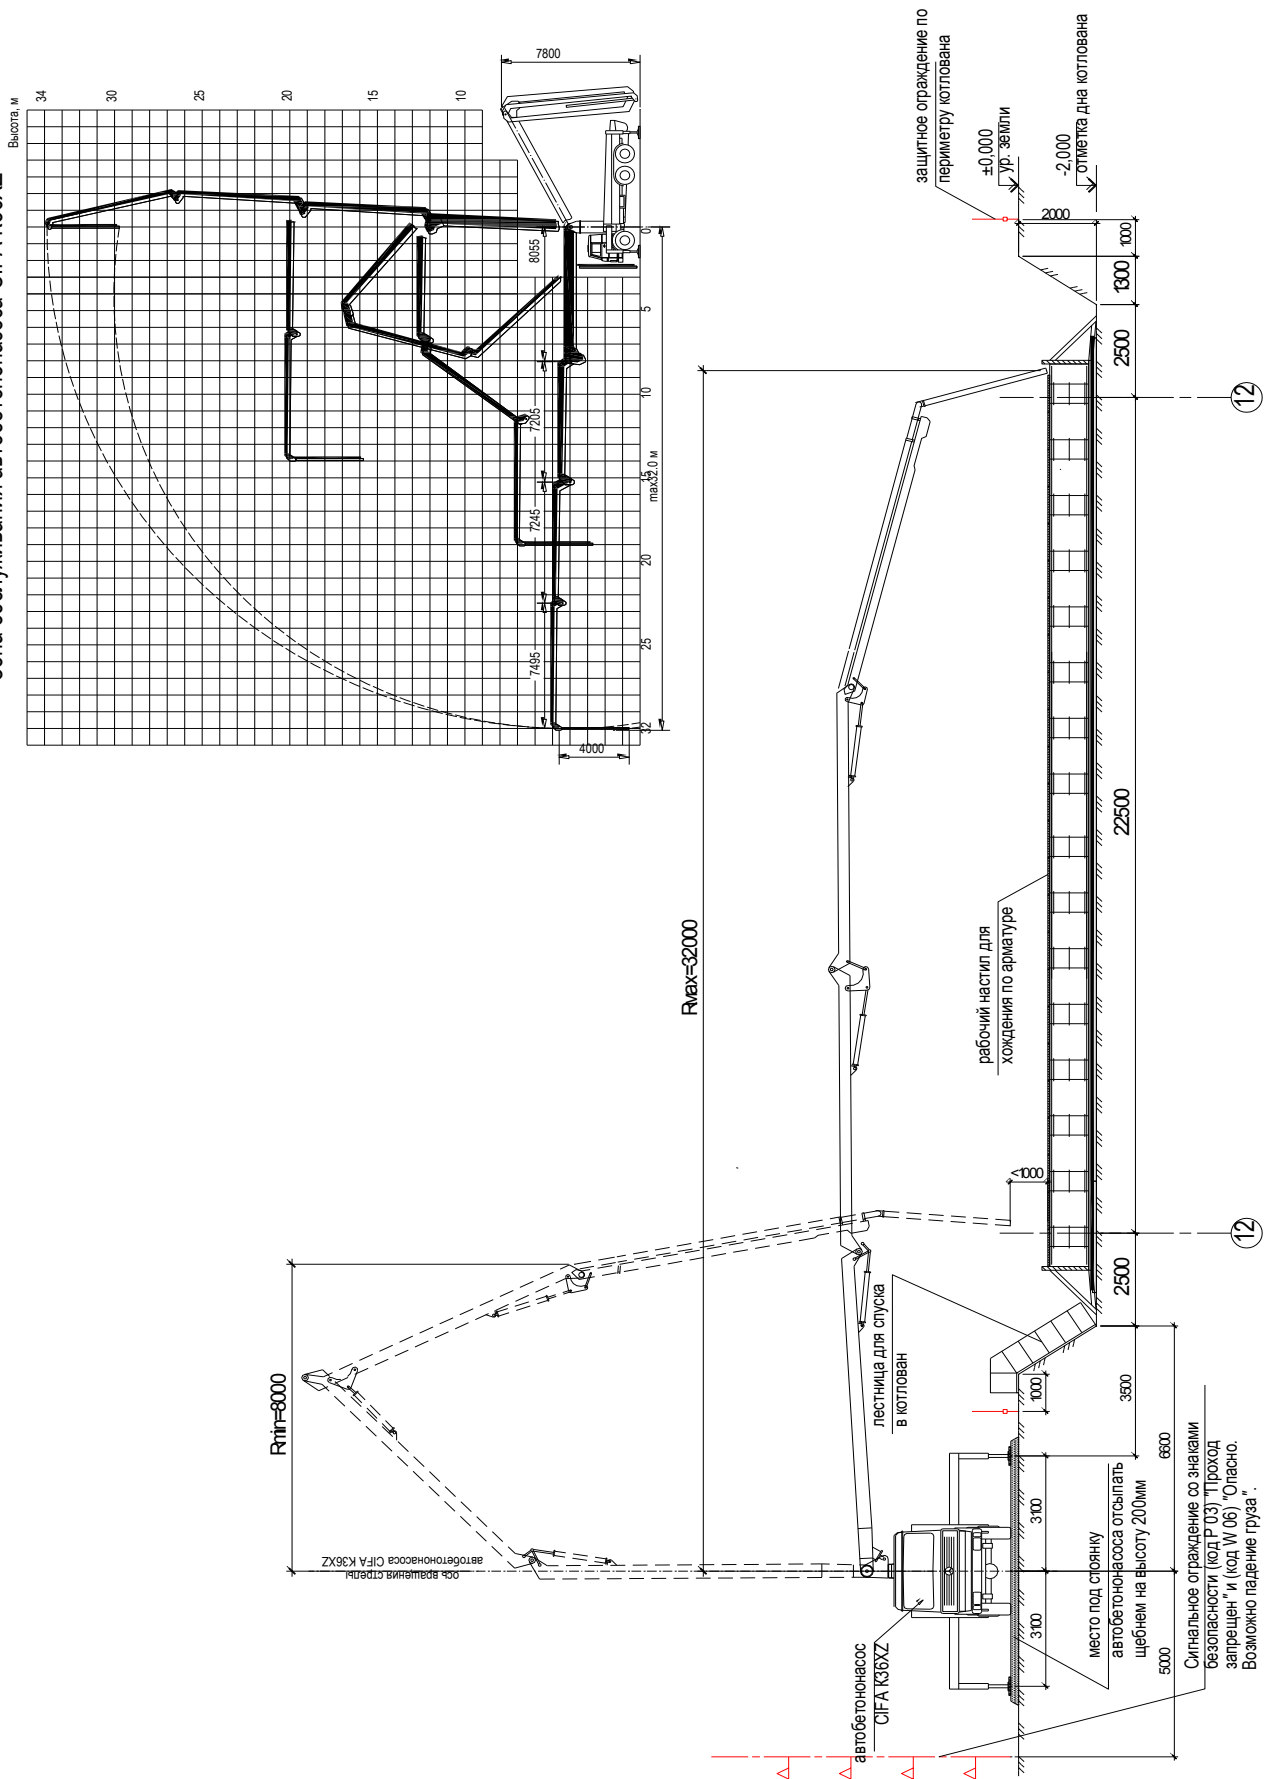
Разрез 1-1 к схеме производства работ по бетонированию фундаментной ПЛИТЫ
